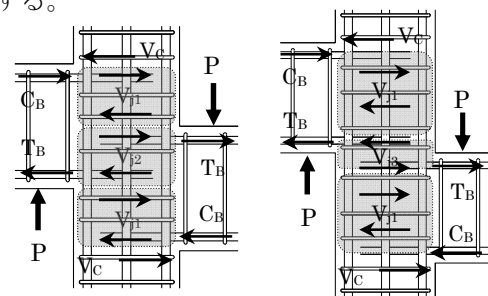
接合部内部のひび割れ・破砕状況
